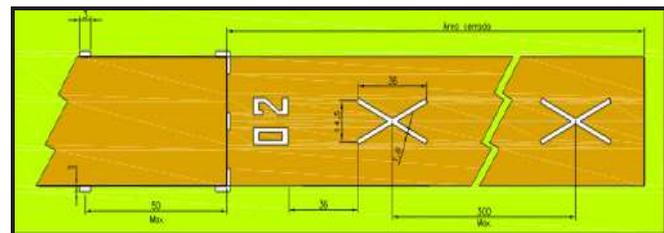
SEÑAL DE ZONA CERRADA EN PISTAS NO PAVIMENTADAS
